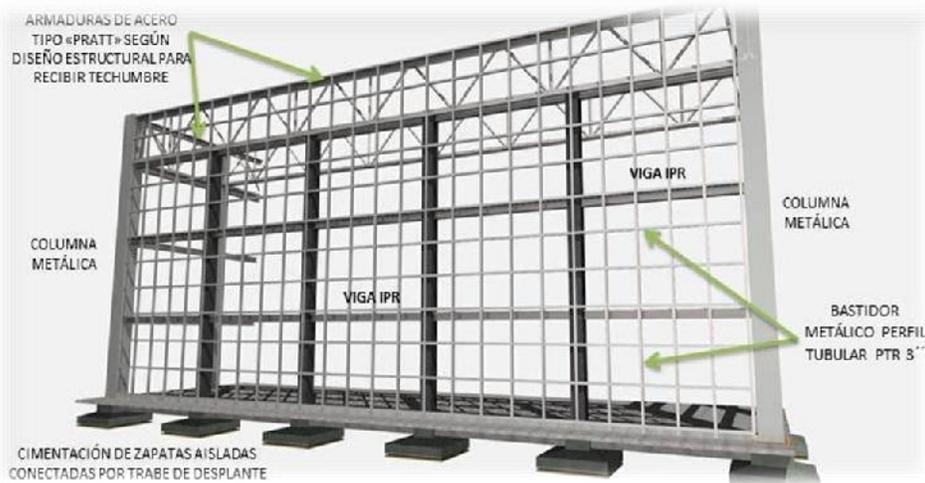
Detalles constructivos de la estructura metálica y de los recubrimientos exteriores del auditorio “Caja Negra”. La propuesta de techumbre para el espacio fue a base del sistema constructivo “Multytecho”. Imagen realizada por: Martín Rubio Avalos e Ismael Vázquez Betanzos. Programa de edición: ArchiCAD Graphicsoft.
